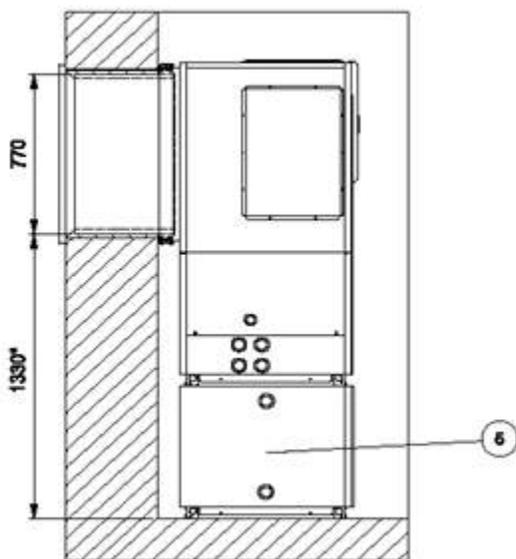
Installazione con bollitore sottostante - vista laterale
